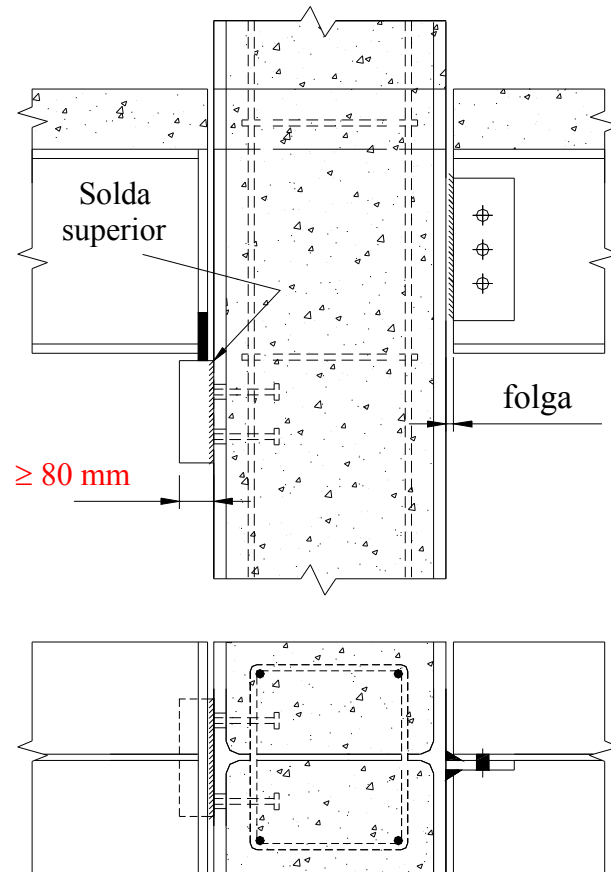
Exemplos de ligação entre viga e pilar misto parcialmente revestido com concreto
